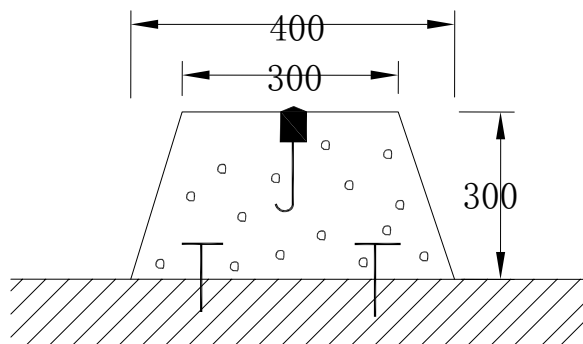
建筑物 CP0 平面控制点标石 (单位: mm)
